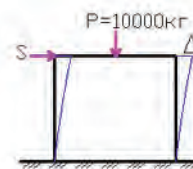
Схема загрузки одноэтажного фрагмента здания горизонтальной нагрузкой
